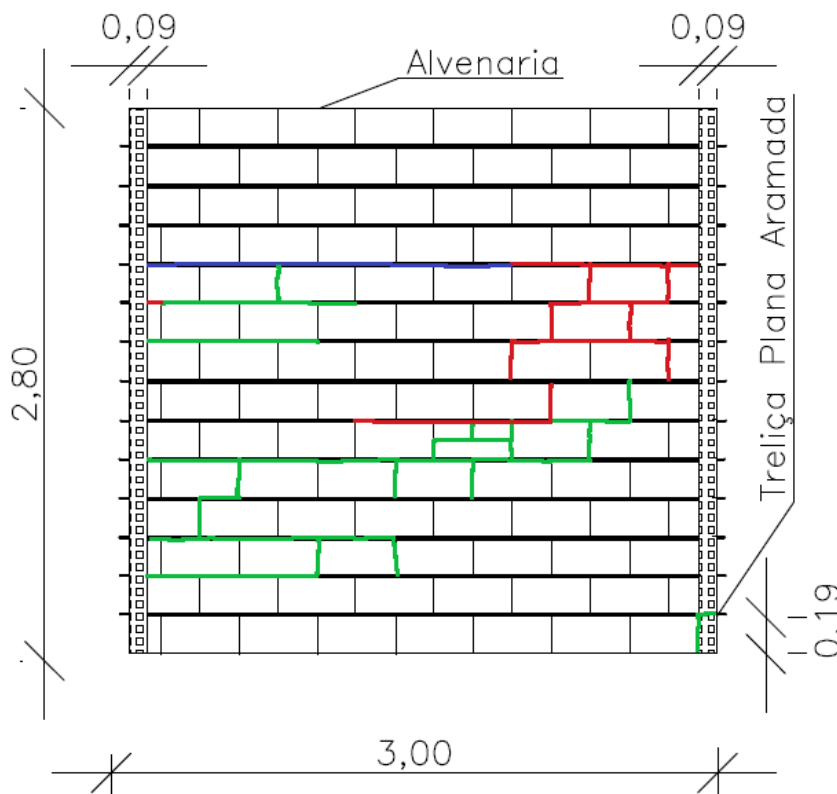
Mapeamento de fissuras da segunda alvenaria ALV – 6 (Vista frontal)
